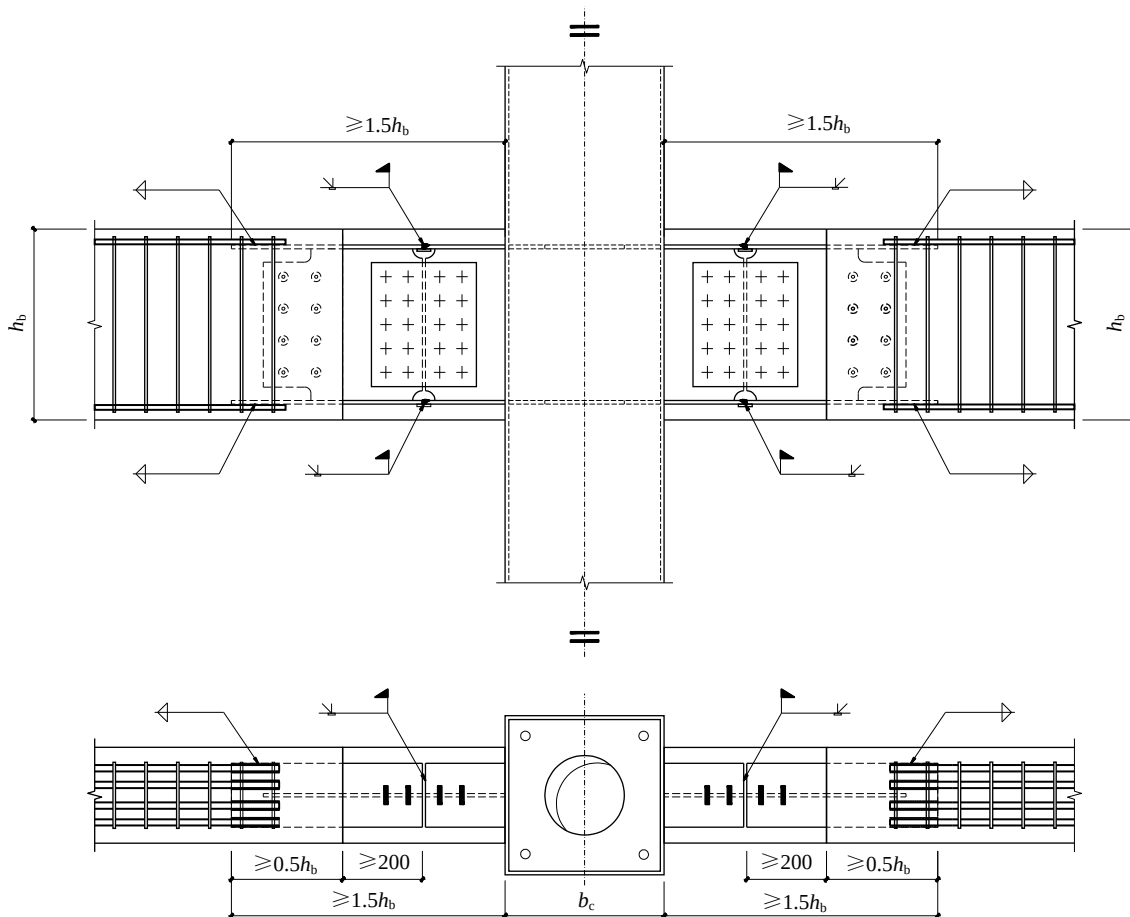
预制混凝土梁-钢管混凝土柱带牛腿内隔板式连接节点
